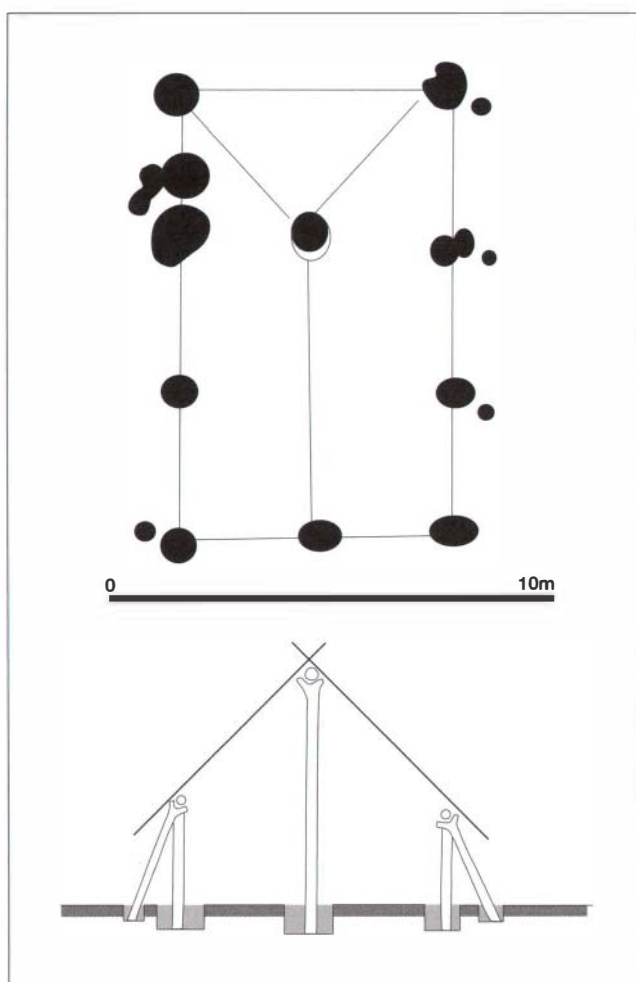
Plan des négatifs d'un bâtiment du haut Moyen Âge à poteaux porteurs de la panne faîtière et parois à poteaux sur le site de l'ancien Haute-Yutz. Restitution en élévation, directions des forces exercées par la toiture. L'enfoncement des poteaux dans le sol sert à assurer la résistance de la structure aux efforts latéraux, principalement les efforts dynamiques dus au vent (contreventement). Cet enfoncement n'est pas nécessaire à la tenue statique de la construction.
